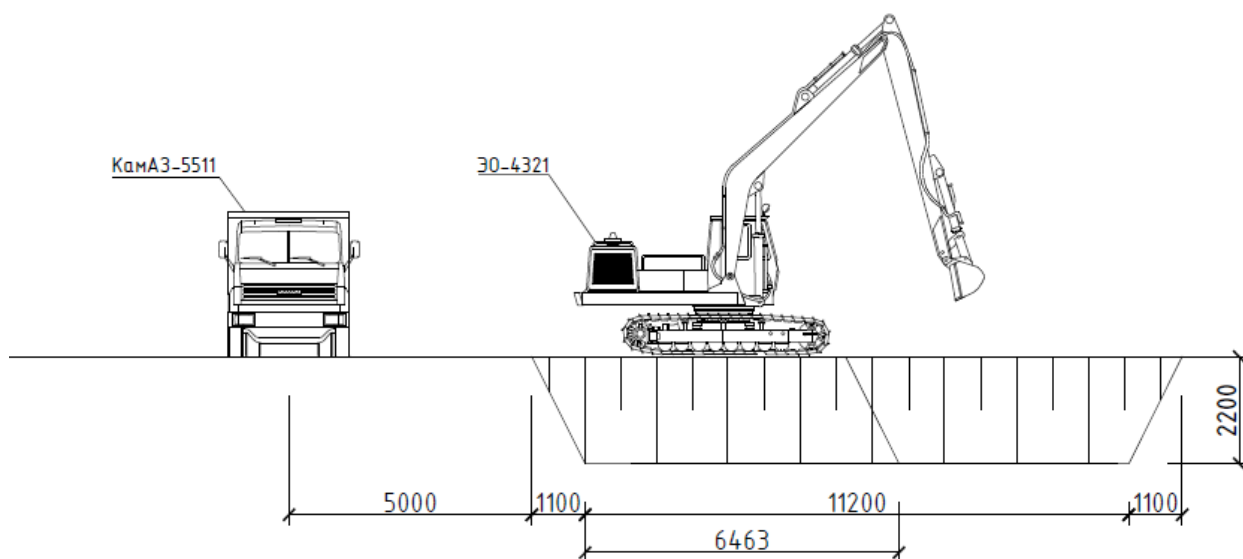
Технологическая схема разработки котлована. Разрез 1-1
